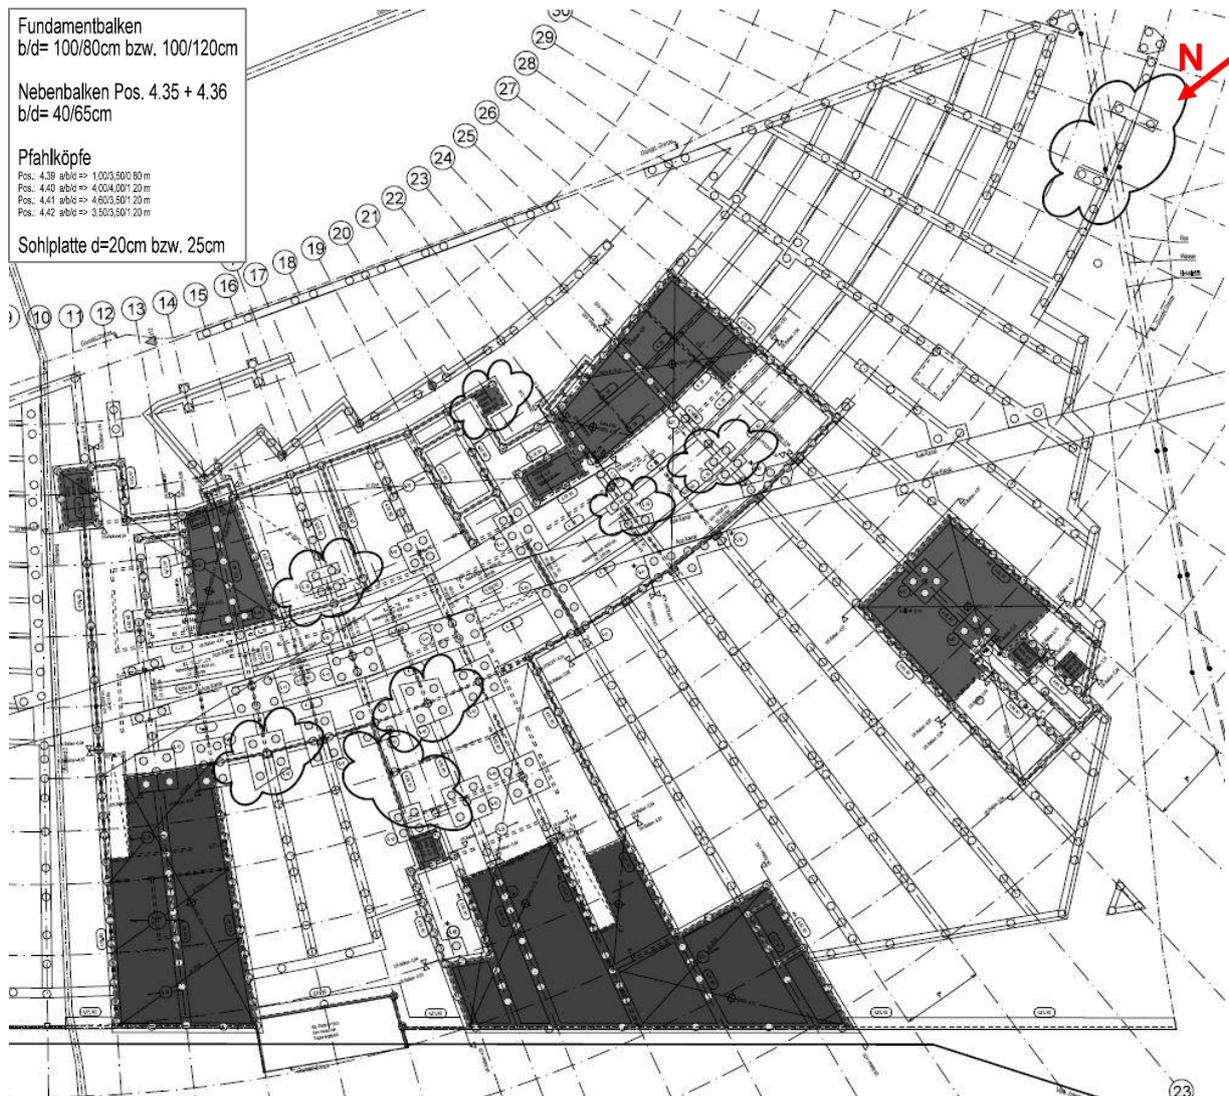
Gründung unter Kellergeschoss – Ausschnitt aus dem Plan BSP02-01 i (Stand: 16.11.2001)
